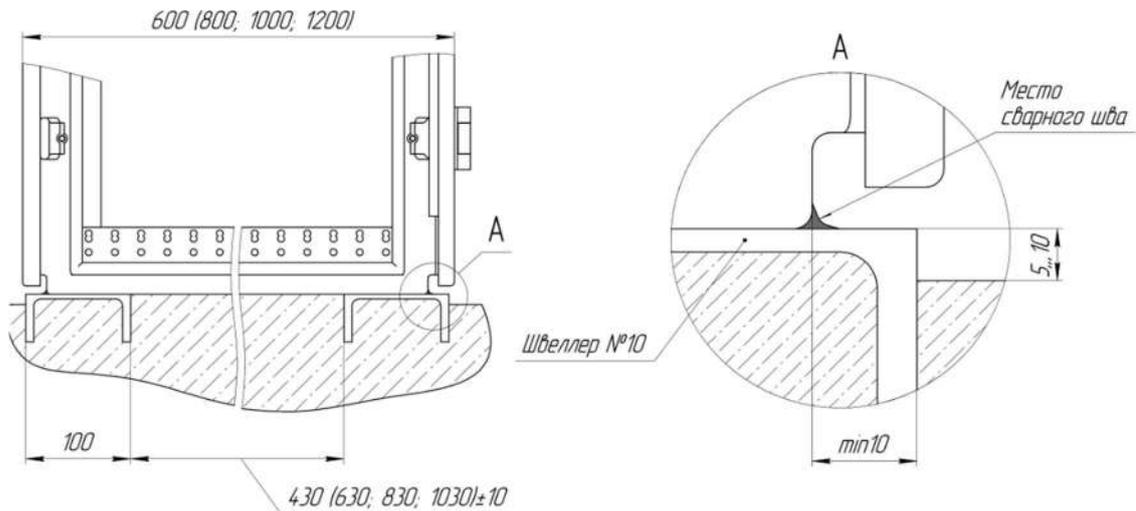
Крепление ГРЩ к закладным элементам при помощи сварки
